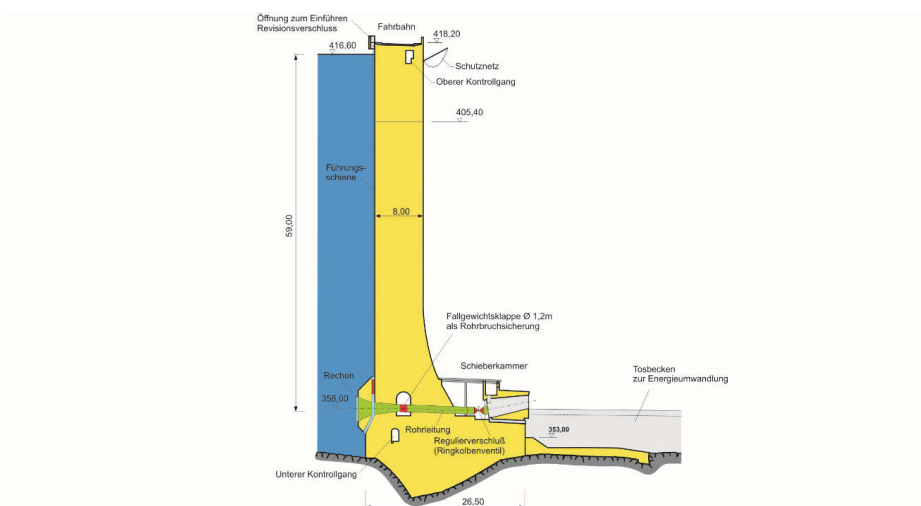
Okertalsperre Hauptsperre Querschnitt Grundablass
